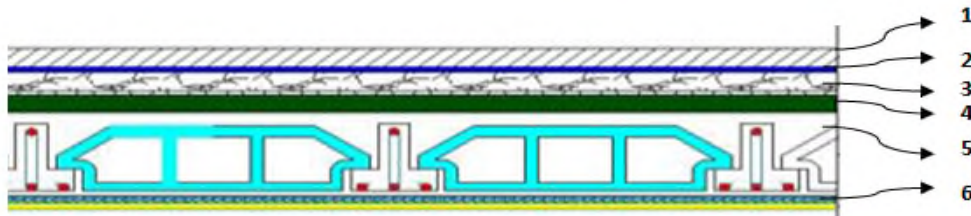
coupe transversal du plancher terrasse inaccessible
